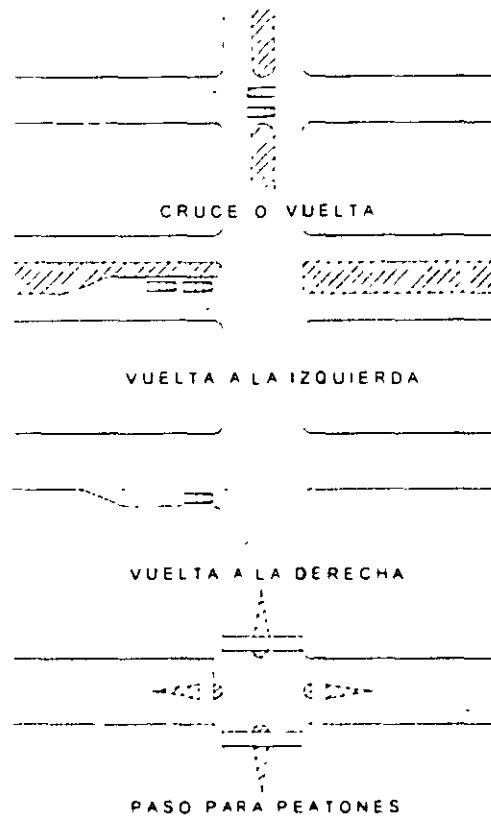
EJEMPLOS DE ZONAS DE PROTECCION
